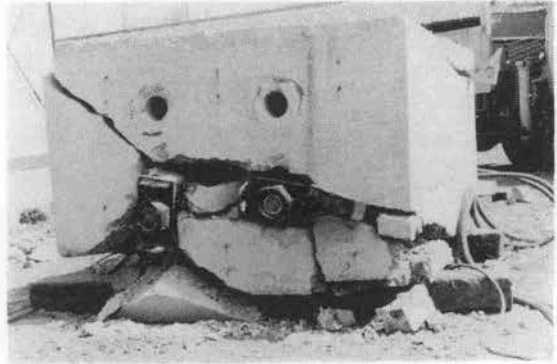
引込式コンクリート破壊機による破壊状況 (チゼル側)
